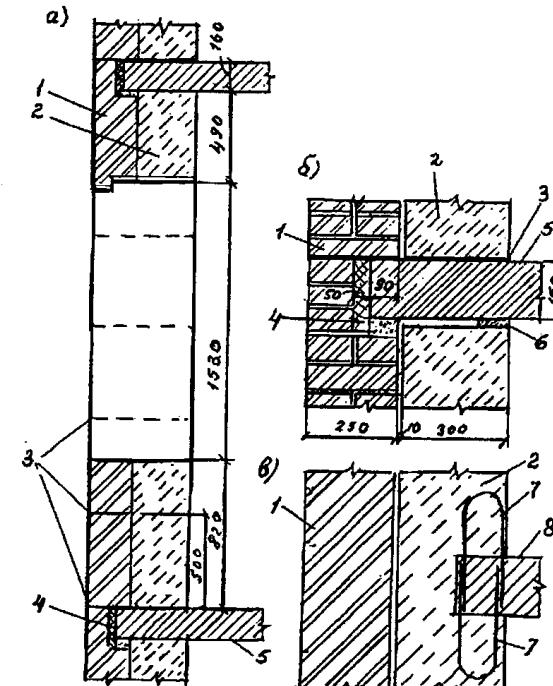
Сечение по наружной двухслойной стене (а) узел со-
